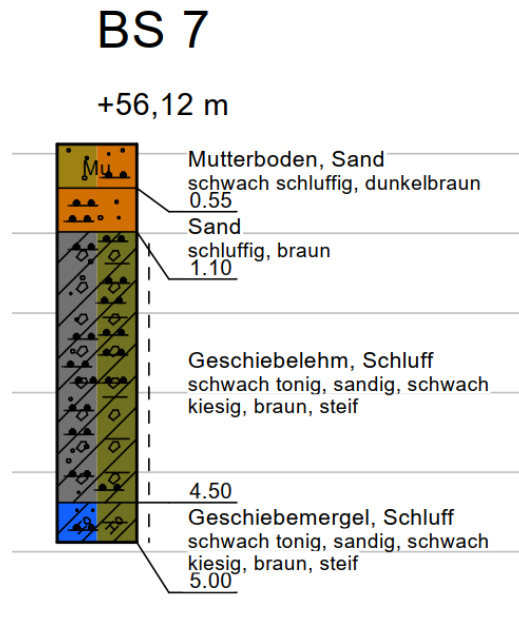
Ausschnitt aus dem Baugrundgutachten. Profil BS 7 (Quelle: Büro GBU 04/ 2023)
